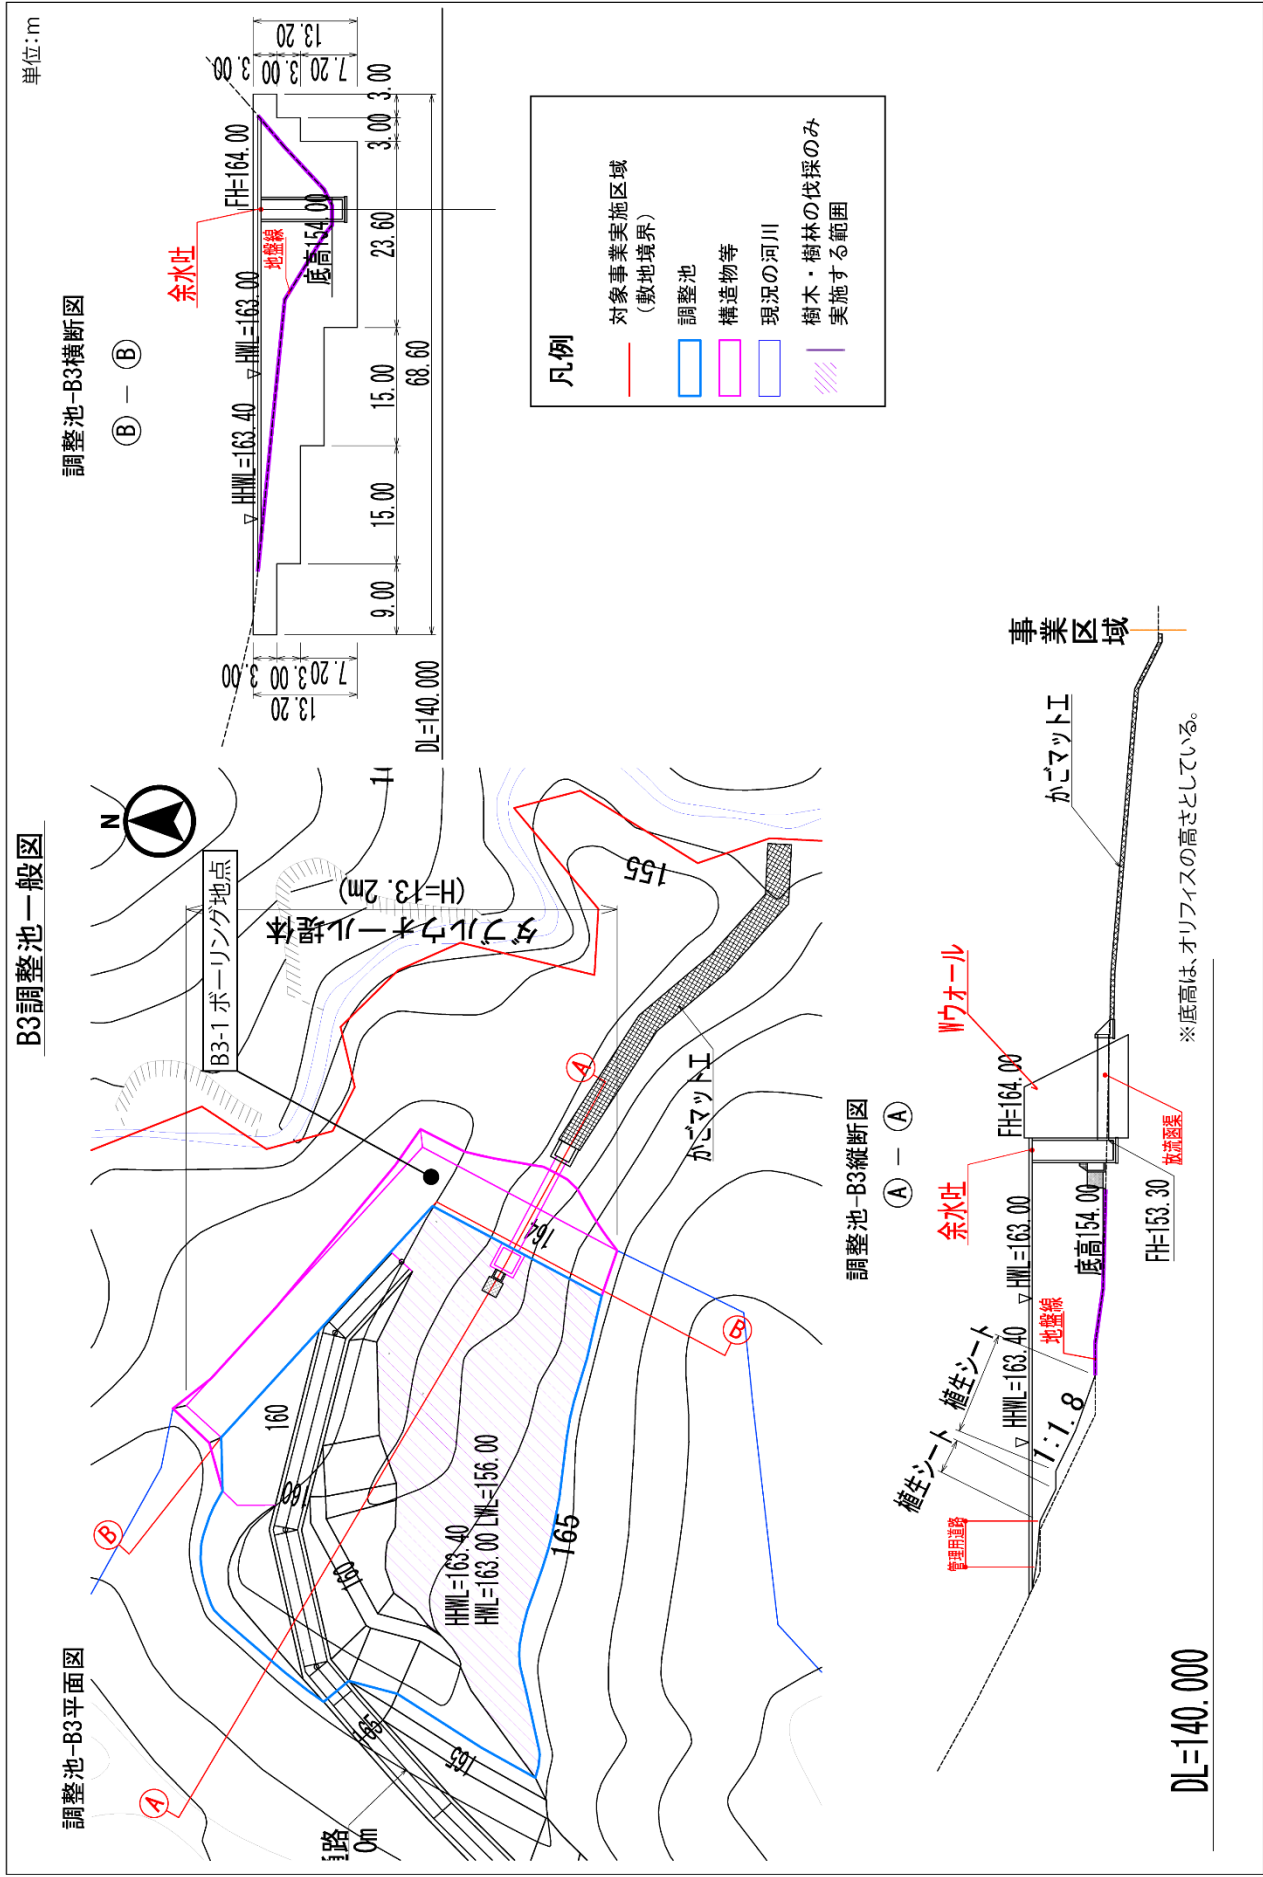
(6) 調整池の平面図・断面図 (B3)
